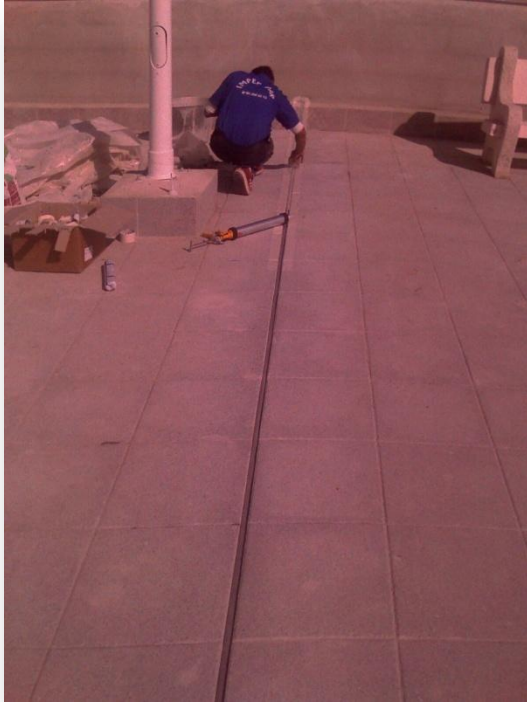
Relleno de junta de pavimento con masilla de poliuretano
